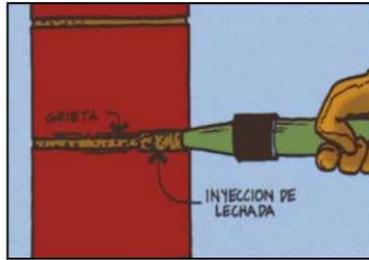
Inyección de grietas con lechada de mortero (AIS 2002)
